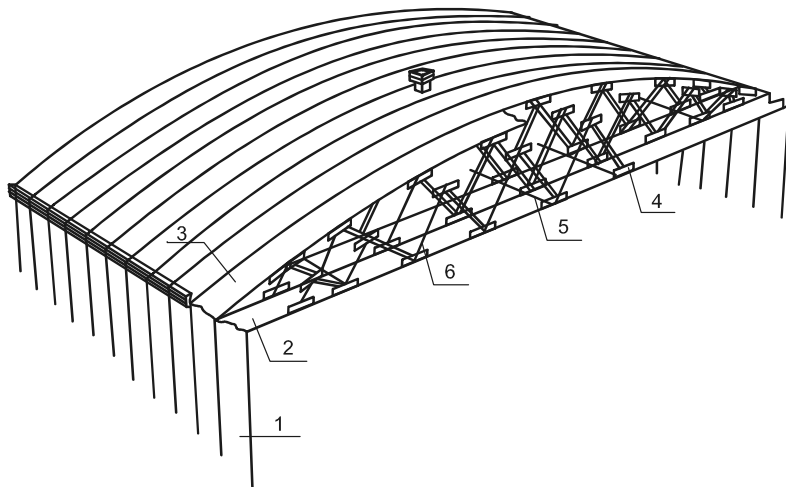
Элементы конструкции: 1 — структурный элемент стены; 2 — структурный элемент потолка (нижний пояс кровельной стропильной фермы); 3 — структурный элемент кровли (верхний пояс кровельной стропильной фермы); 4 — фасонки; 5 — распорки из Z-образных холодногнутых профилей; 6 — раскосы из С-образных холодногнутых профилей
